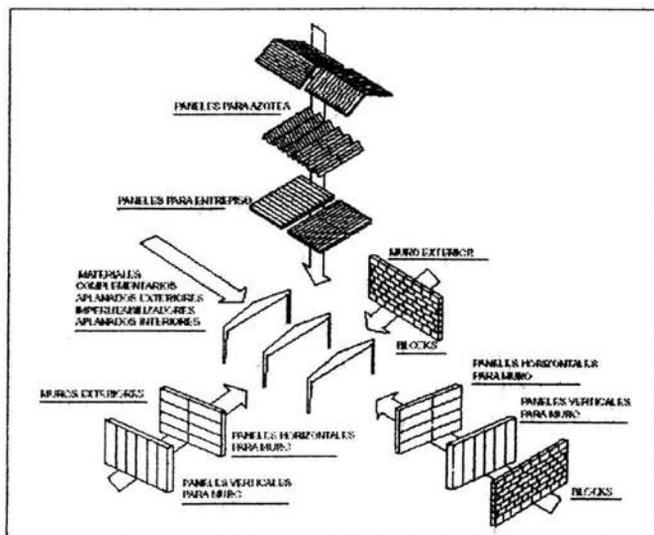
Sistema constructivo para proyectos industriales de concreto celular, sistema de estructura de soporte a base de marcos que se recubren con paneles armados para muro que pueden colocarse vertical u horizontalmente, como alternativa se utilizan muros de bloques de concreto celular.
